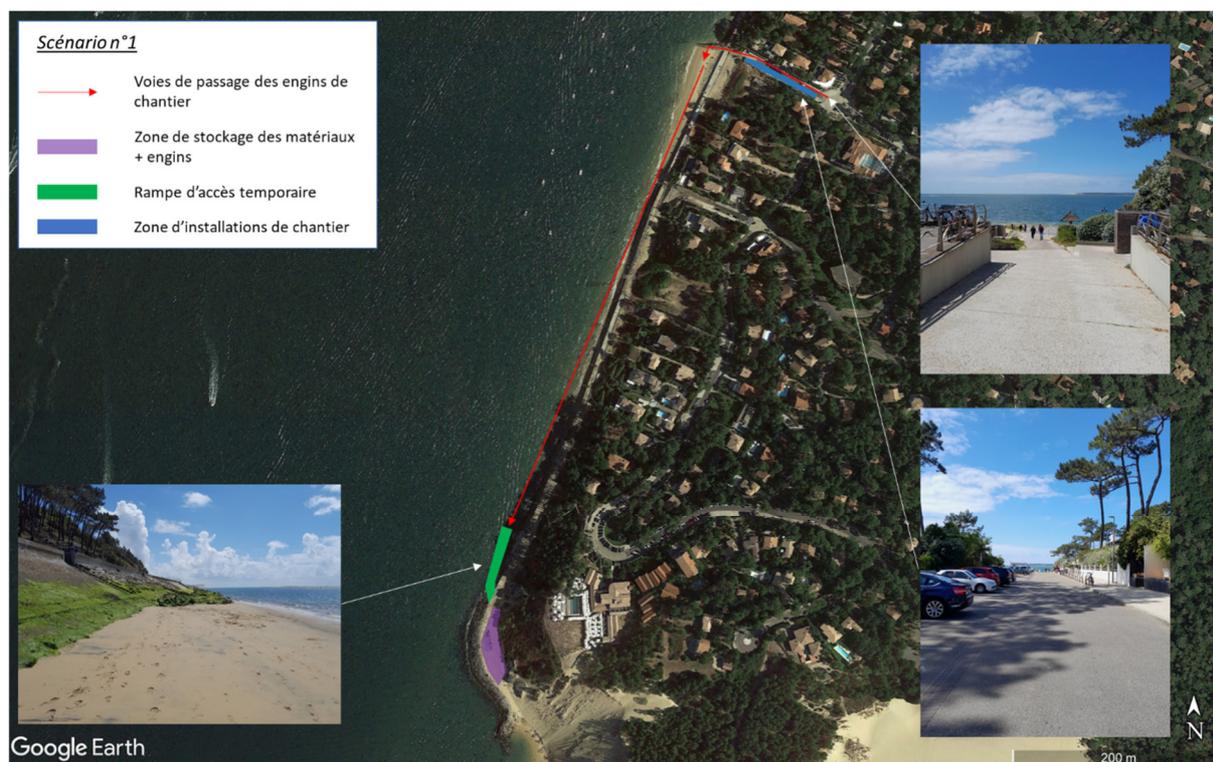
Proposition du scénario d'implantation des installations de chantier, zones de stockage et circulation pour accès et travaux au musoir
